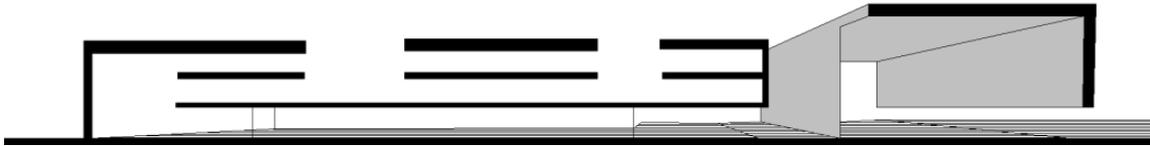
corte transversal del bloque 1 y 3 / Fuente: Elaboración propia
